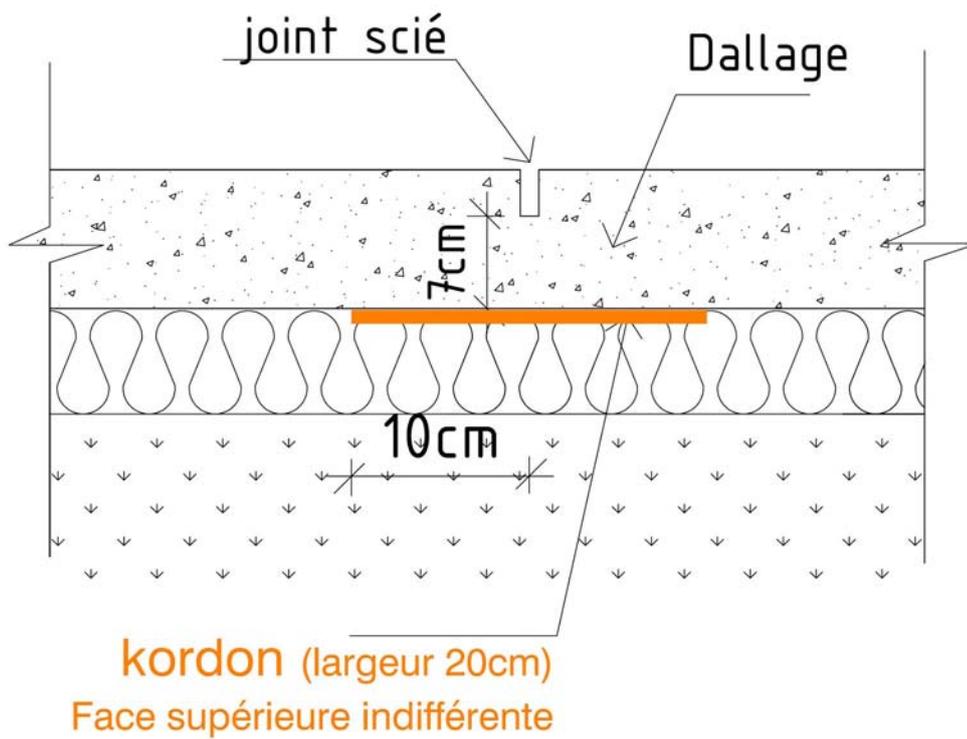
Joint scié pour épaisseur de dallage inférieur à 12 cm. Isolant sous dallage résistant aux termites.
